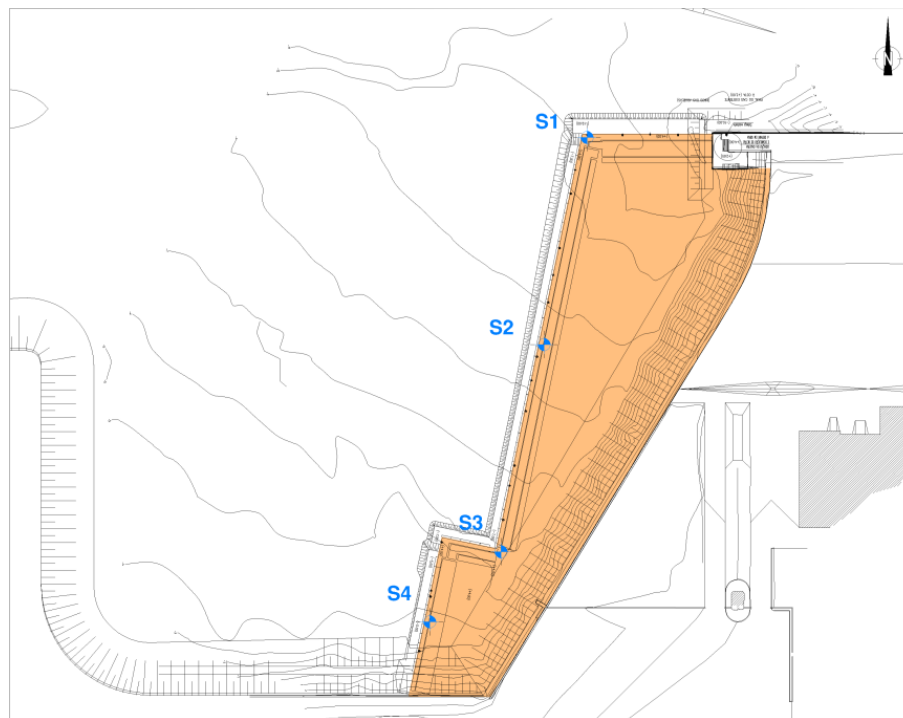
Planta de localização das Sondagens realizadas para a obra do Cais de Passageiros de Praia da Vitória (2004)
